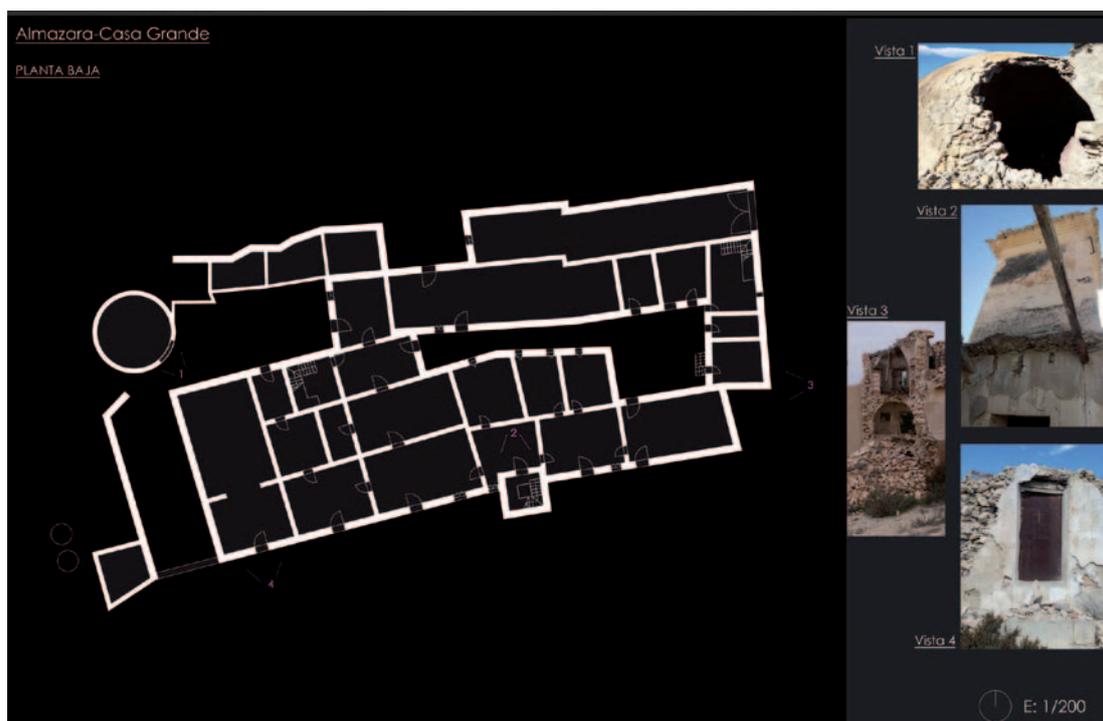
Planta Baja Almazara-Casa Grande. Elaboración Propia.
